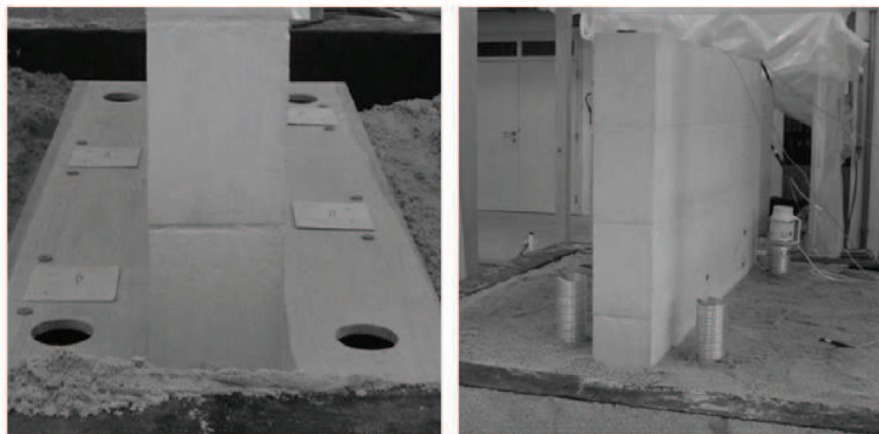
Séchage des parois par ventilation en pied de mur (photos issues de [Torres])
